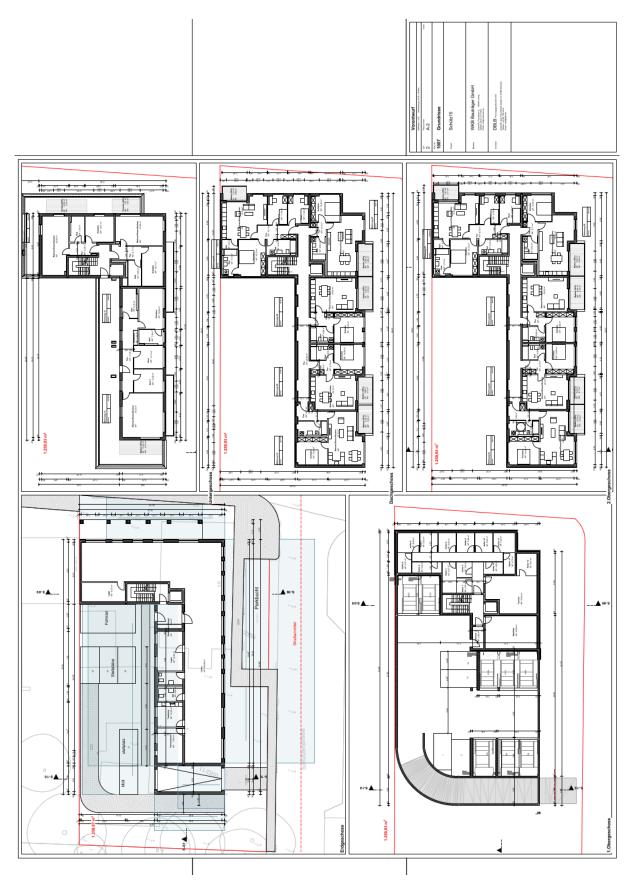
Plandarstellung mit Darstellung der geplanten Geschosse (Vorentwurf, übermittelt am 21.06.2023)
